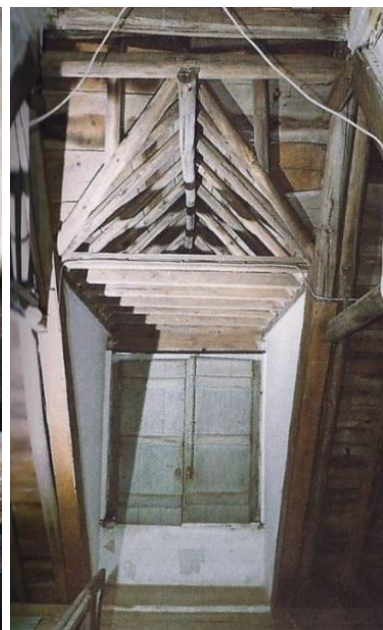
“Estrutura da cobertura. Pormenor da Trapeira.”
